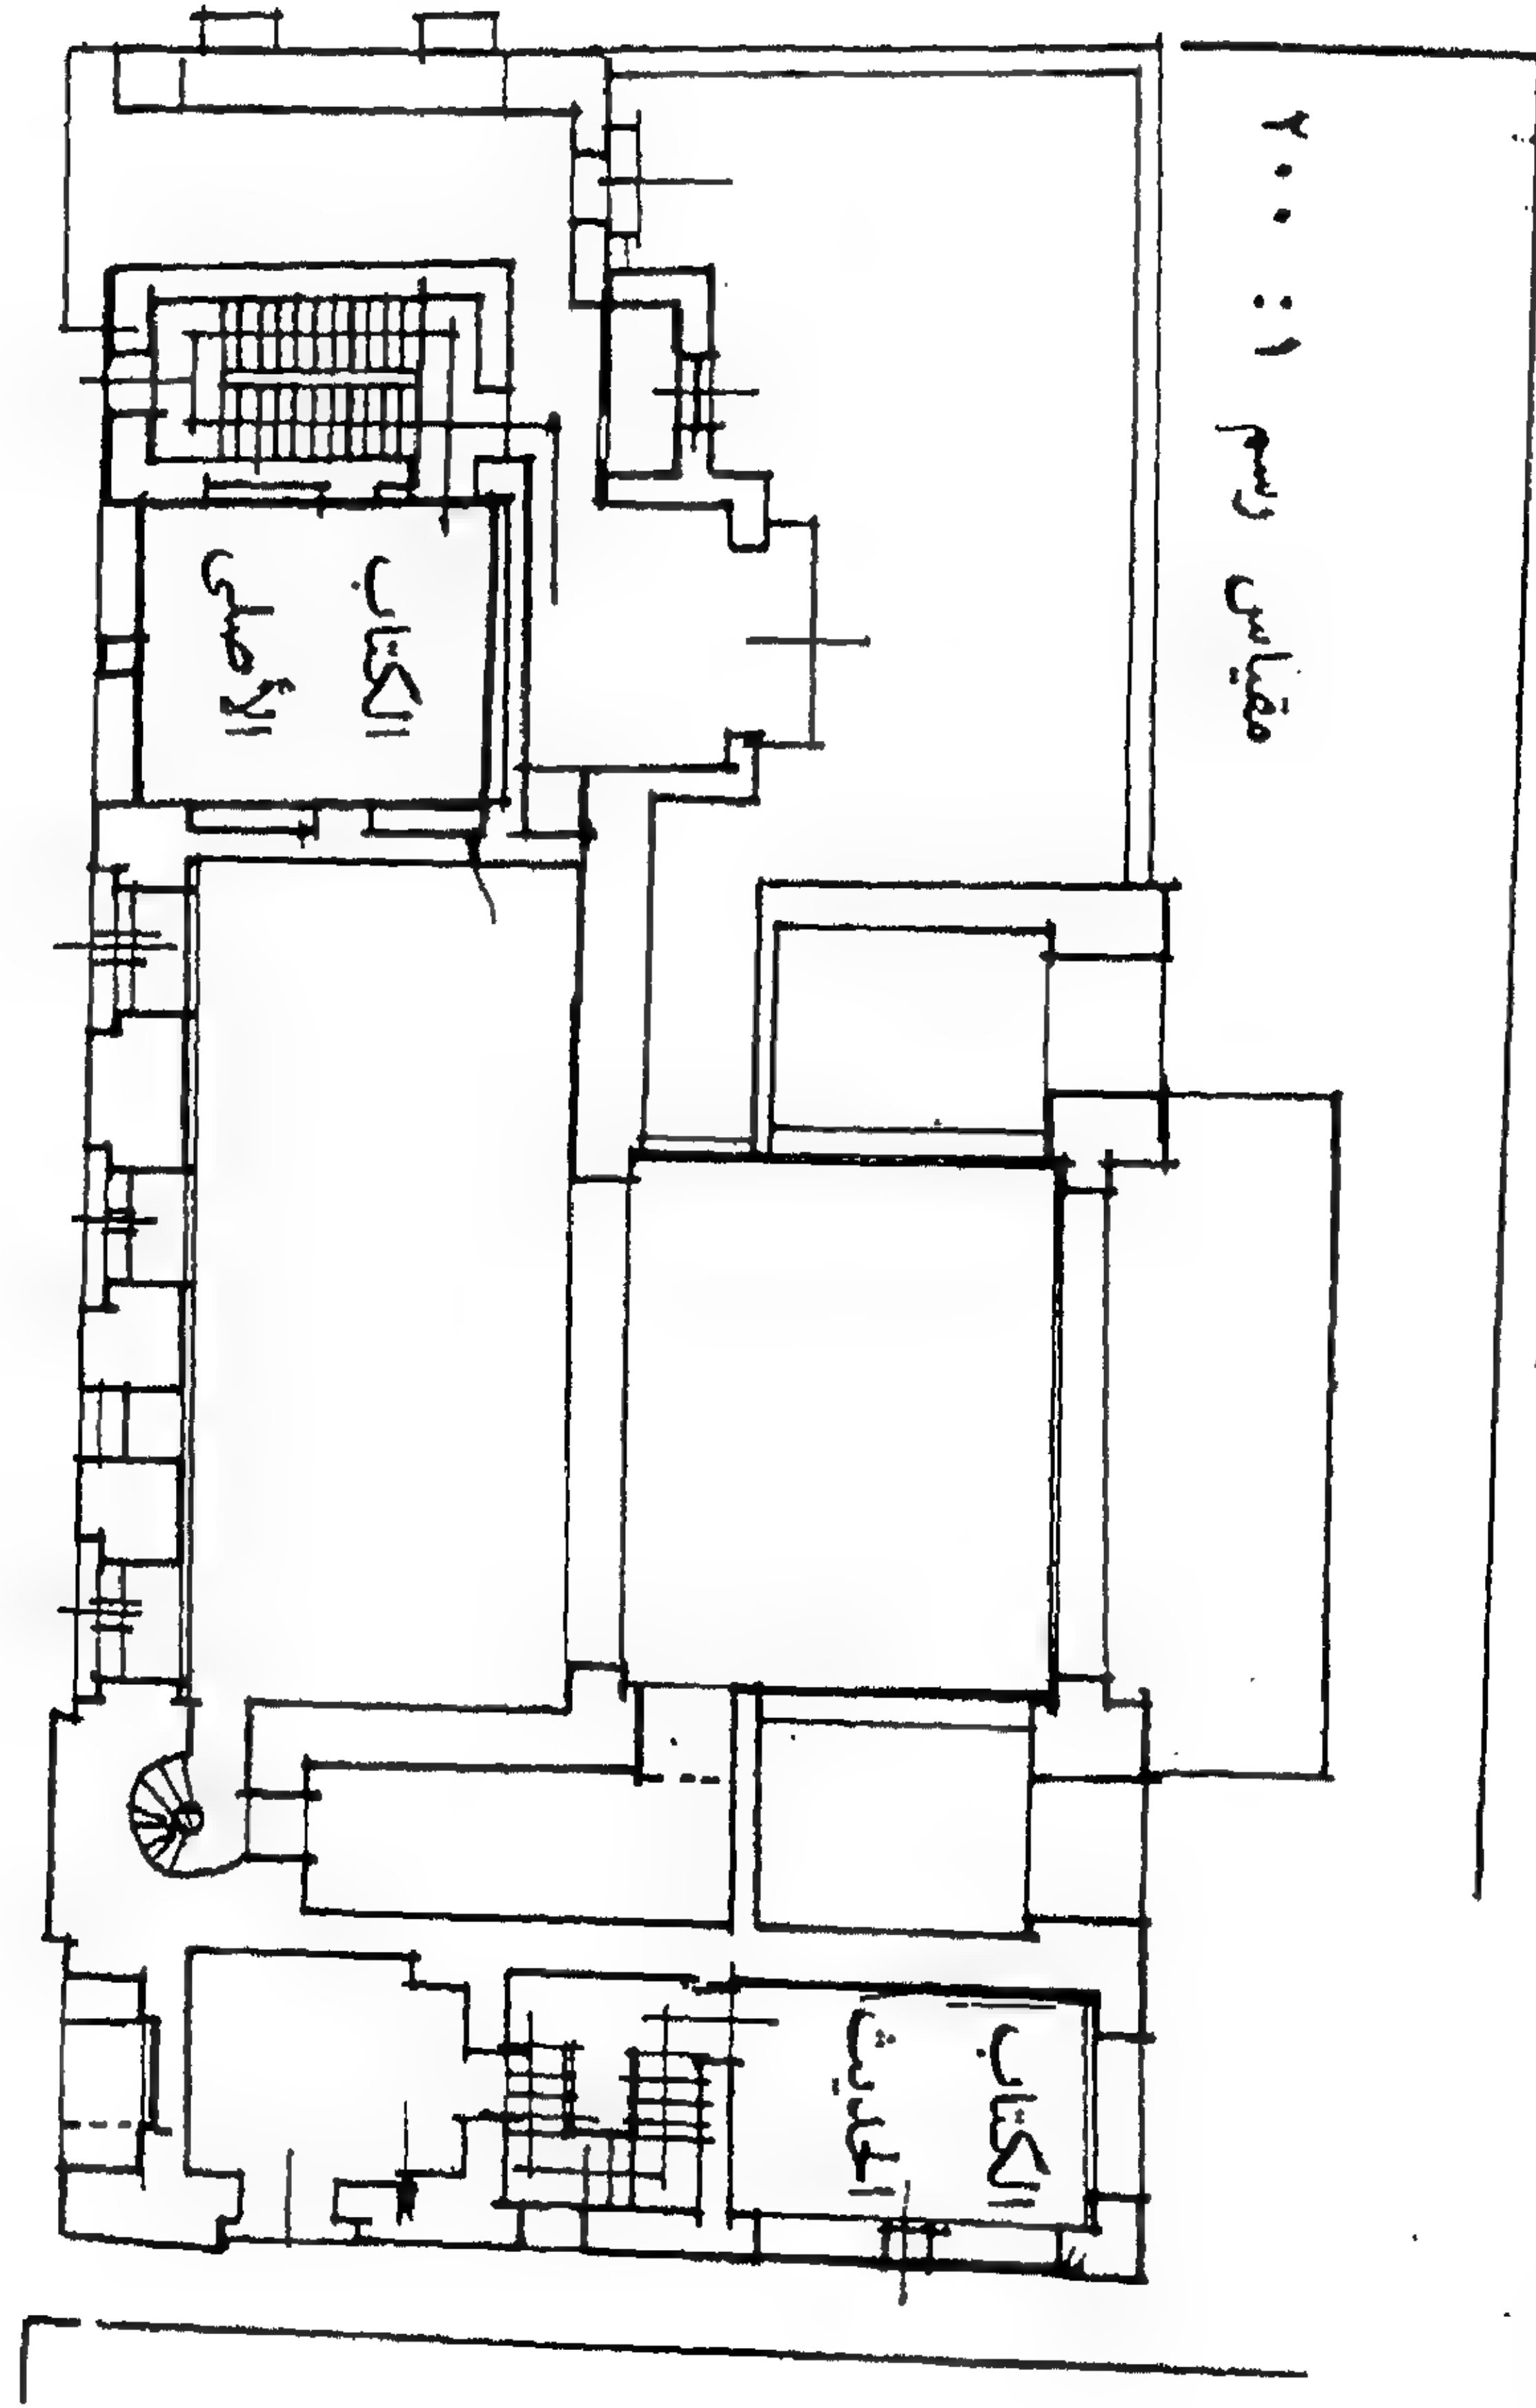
مسقط أفقى لجامع يوسف أغا الحين بميدان باب الخلق.
